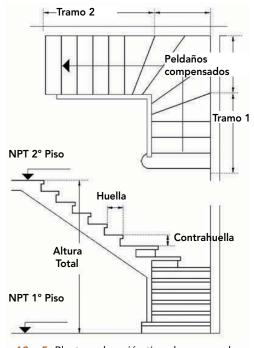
5: Planta y elevación tipo de una escalera de dos tramos en ángulo recto con peldaños compensados.
